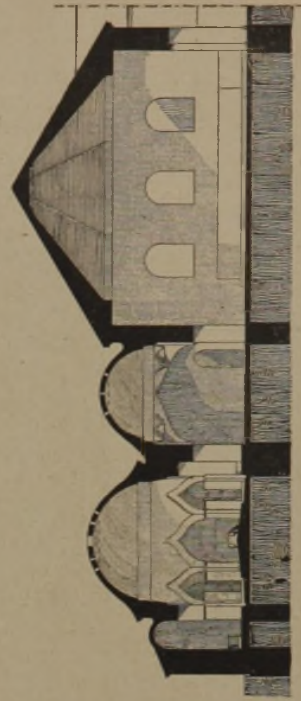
Jeni Dschuma Hamam in Ismid. Schnitt zum Grundrisse Abb. 6, S. 810. (Maßstab 1:300.)
